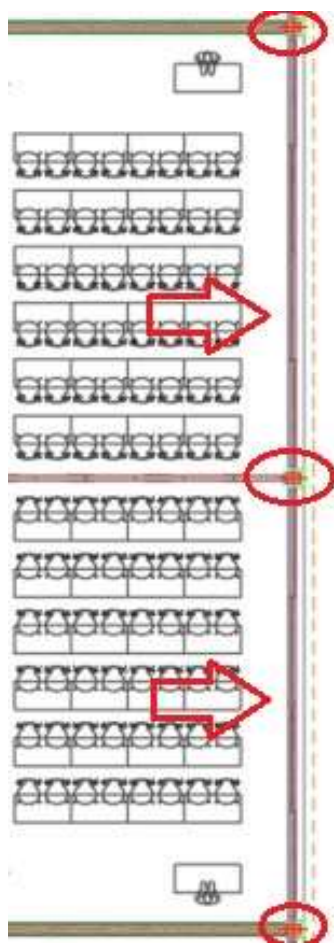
Fachadas - vãos envidraçados (planta).
